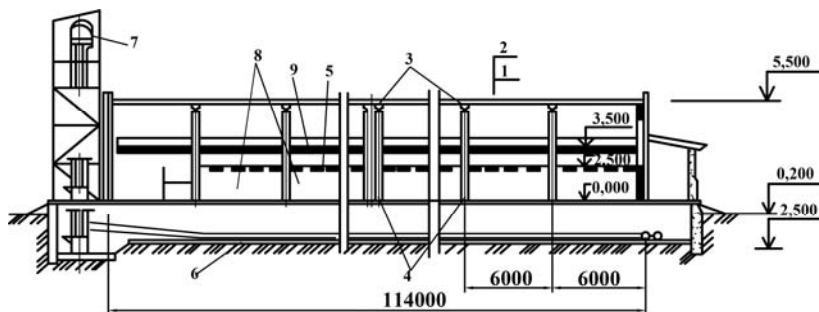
Зерносклад засічного типу з повним залізобетонним каркасом і стінами з залізобетонних панелей:
